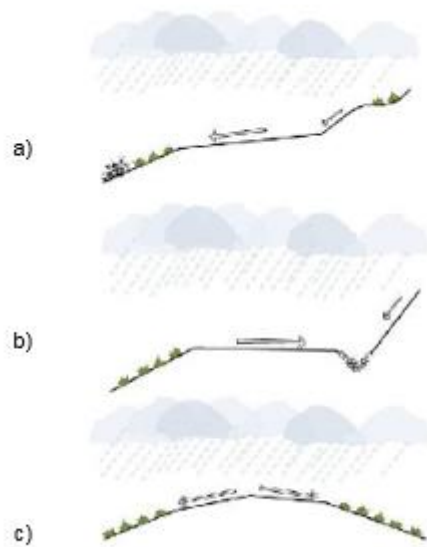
Perfil transversal da estrada: a) Perfil inclinado para o exterior; b) Perfil inclinado para o interior; c) Perfil em "V" invertido (SANTOS, 2013).
